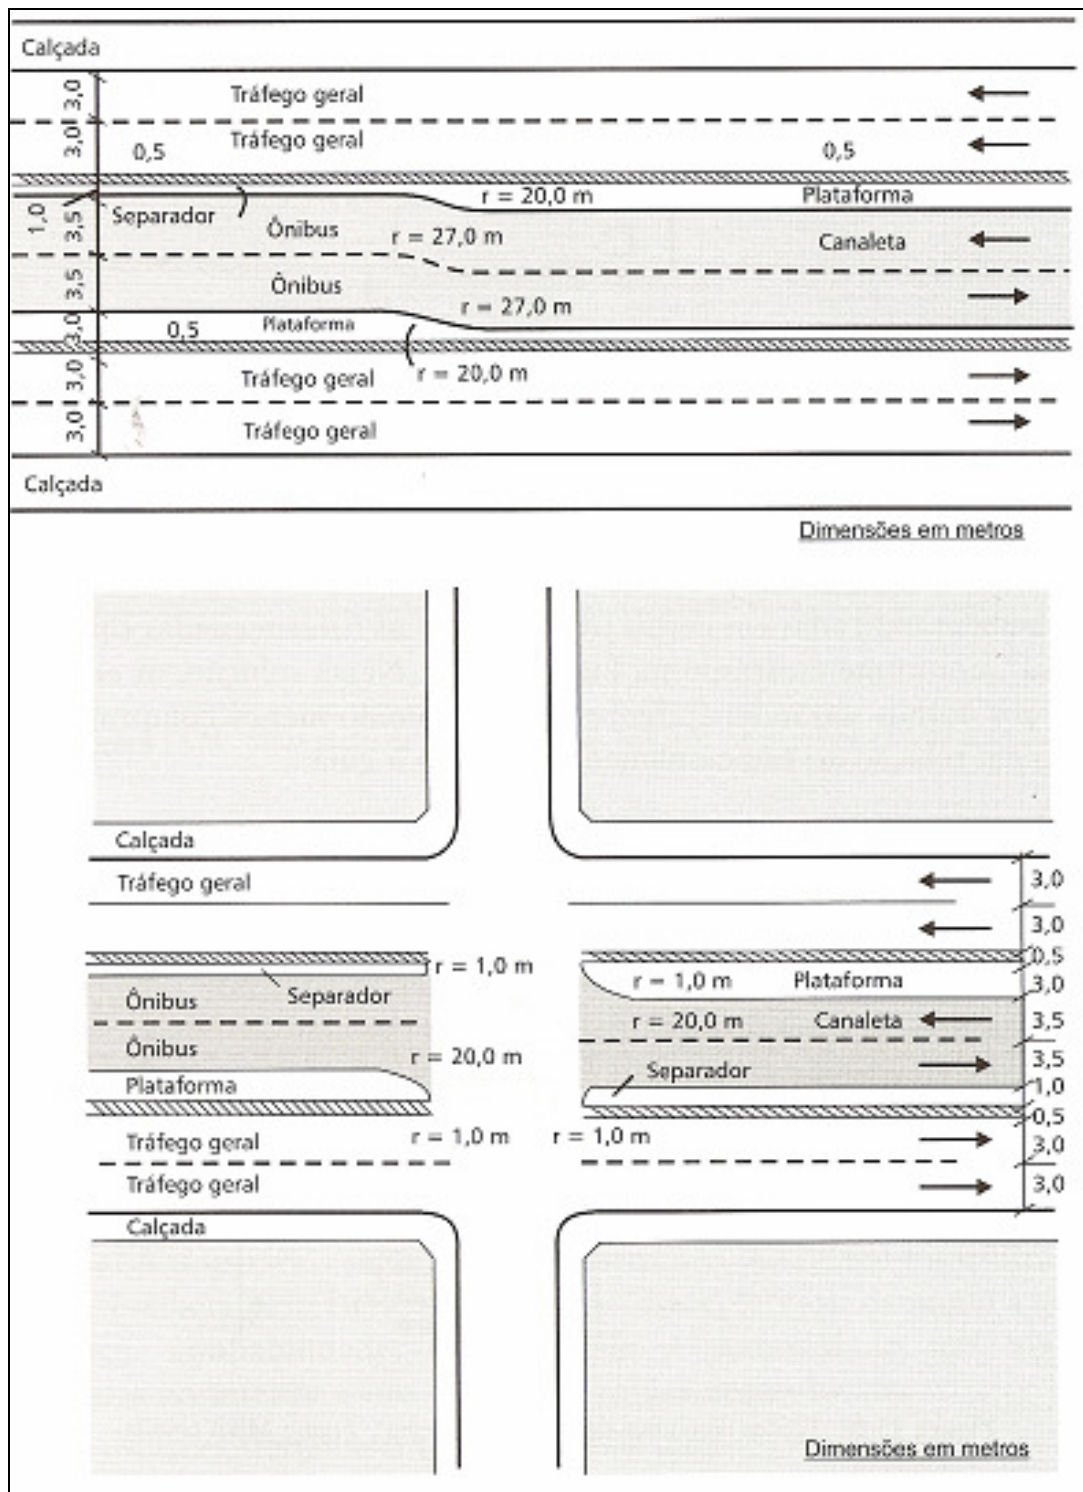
Pontos em canaletas localizadas próximas ao canteiro central e em faixas opostas sem separação física.
